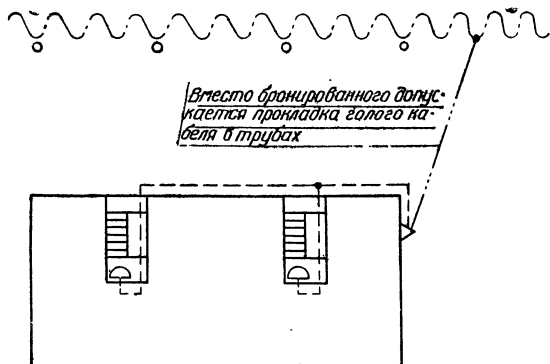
Вывод на наружную стену здания подземным кабелем от кабеля, подвешенного на канате по столбам
